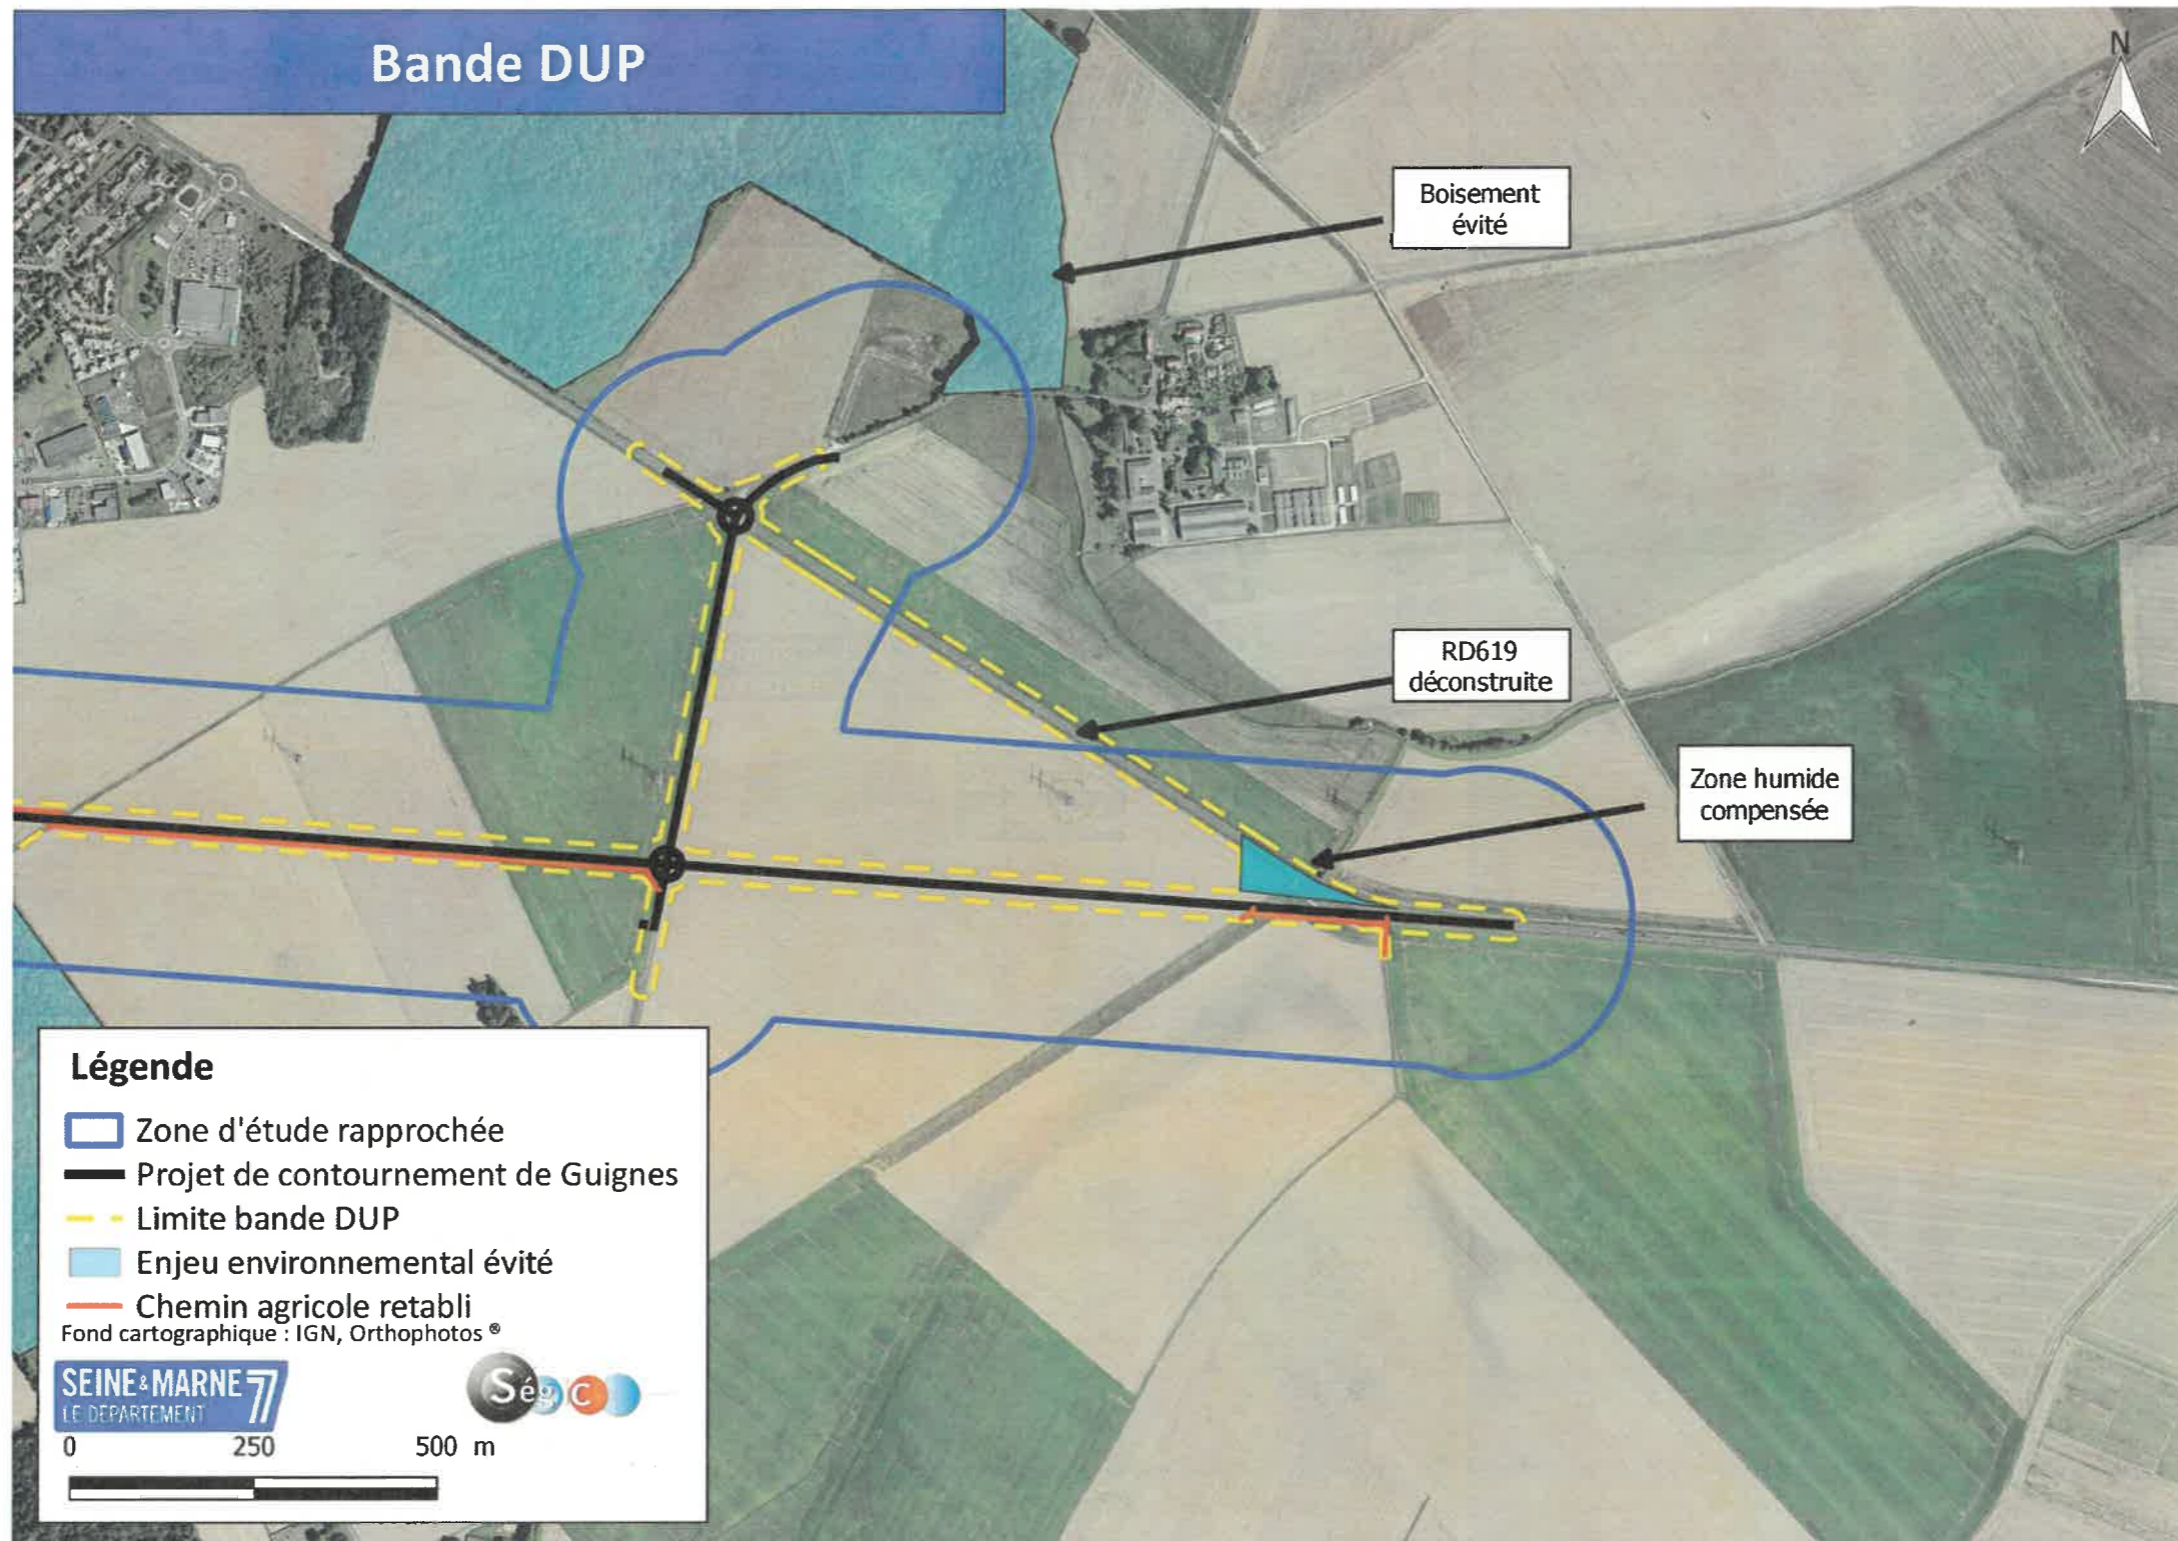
Bande DUP retenue – Planche 4/4 (Source : SEGIC Ingénierie)
